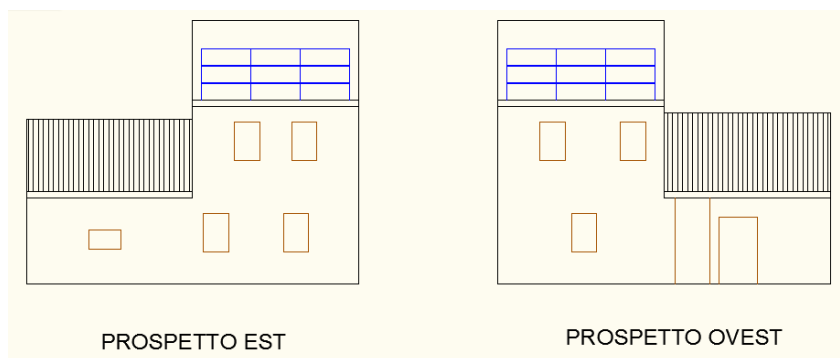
Prospetto Est ed Ovest dell'impianto fotovoltaico.
